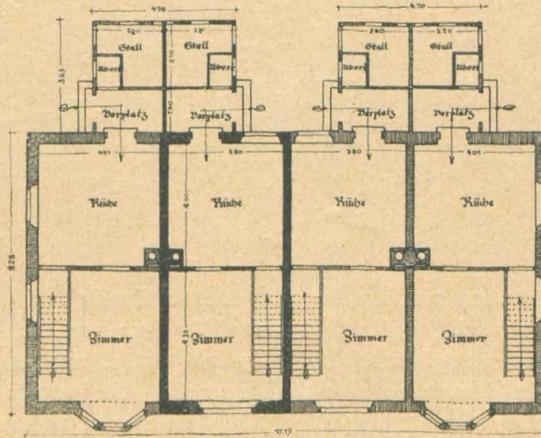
Erdgeschoß-Grundriß. M. 1:250.
